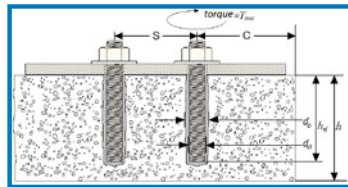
Detalle de instalacion tipica para insertos internamente roscadas
